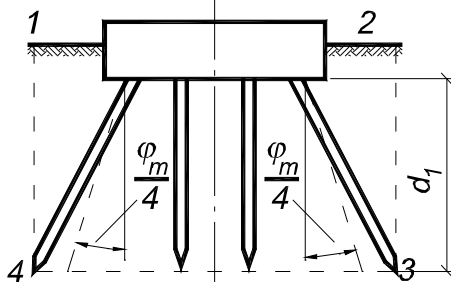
Умовний пальовий фундамент з ростверком, заглибленим в ґрунт при куті нахилу паль, більше ніж $\varphi_m / 4$
